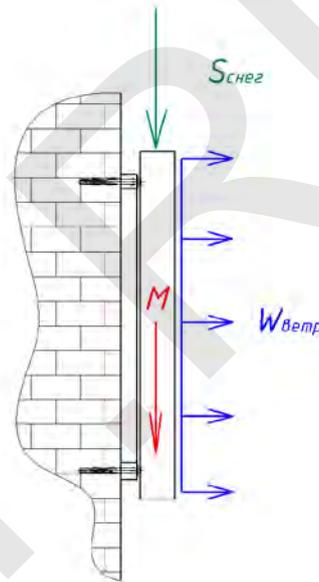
Расчетная схема (тип крепления см. 04.22-114/000.0В)
